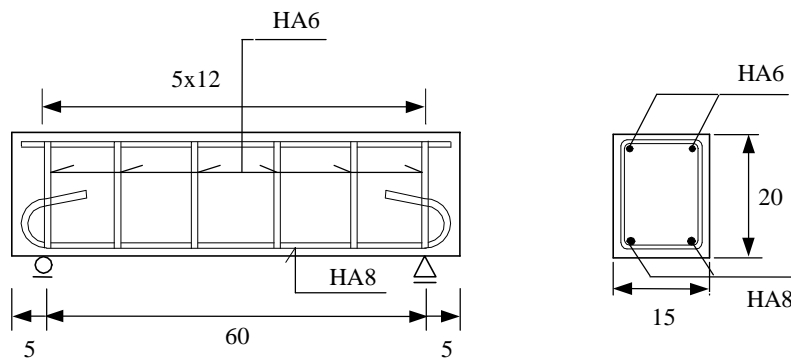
Dimensions et ferrailage des éprouvettes (unité: cm)
